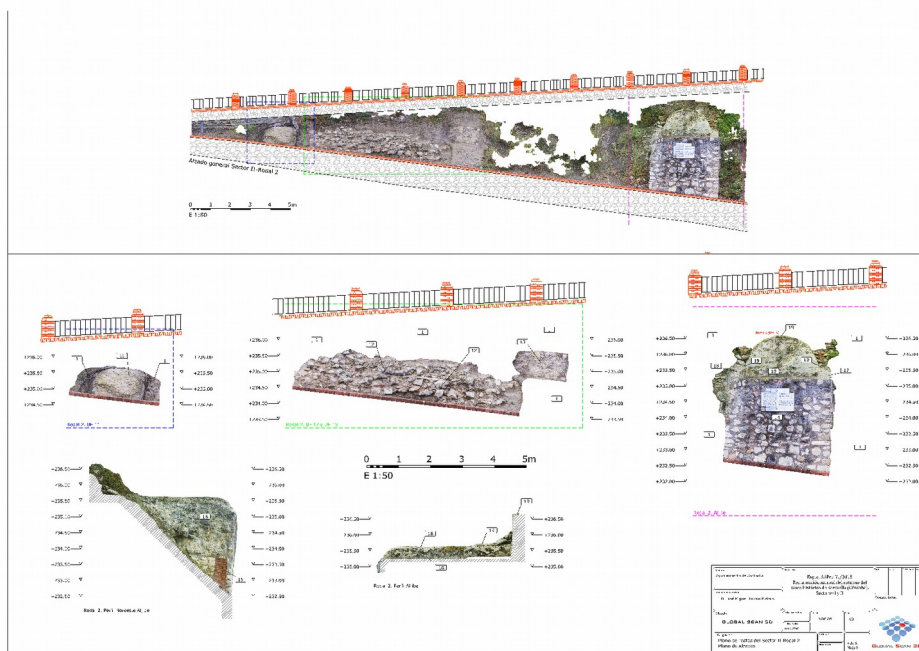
Plano de alzados de los restos localizados en el sector II- Rodal 2.
